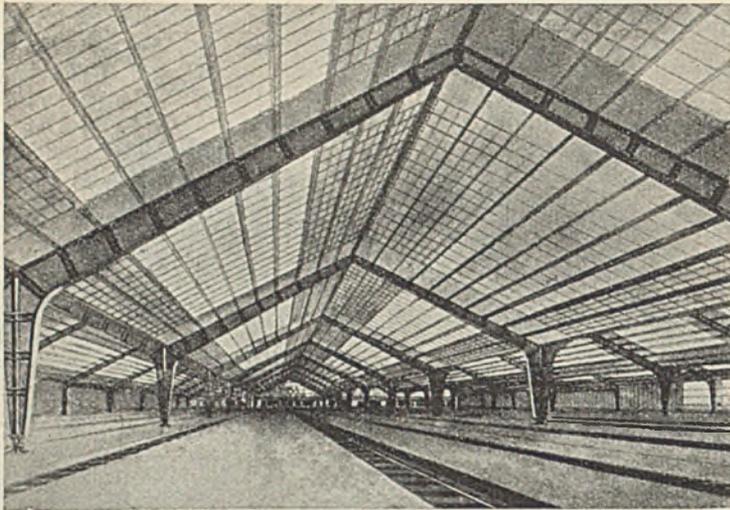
Bahnsteighalle für den Stuttgarter Hauptbahnhof.
